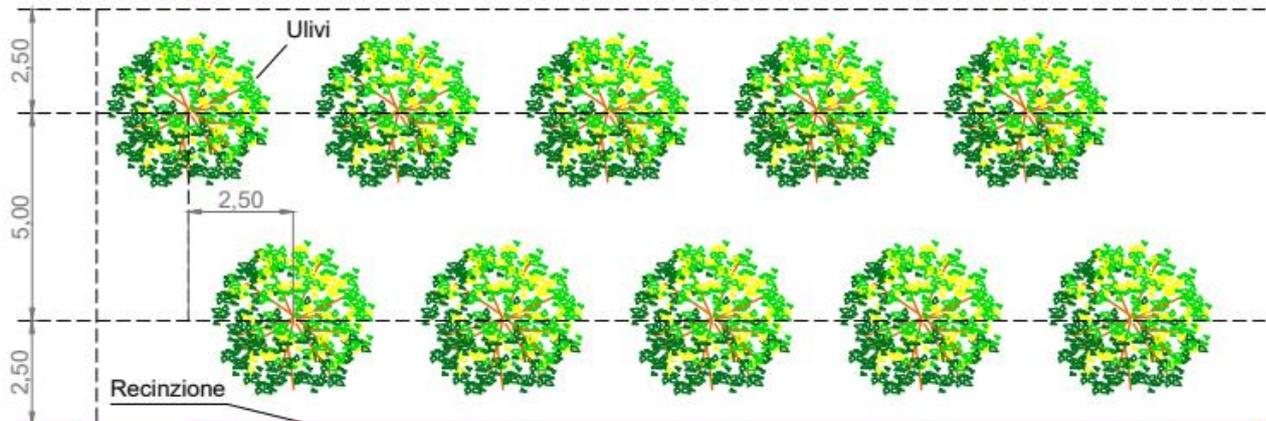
Fascia di mitigazione e schema del sesto dell'impianto
